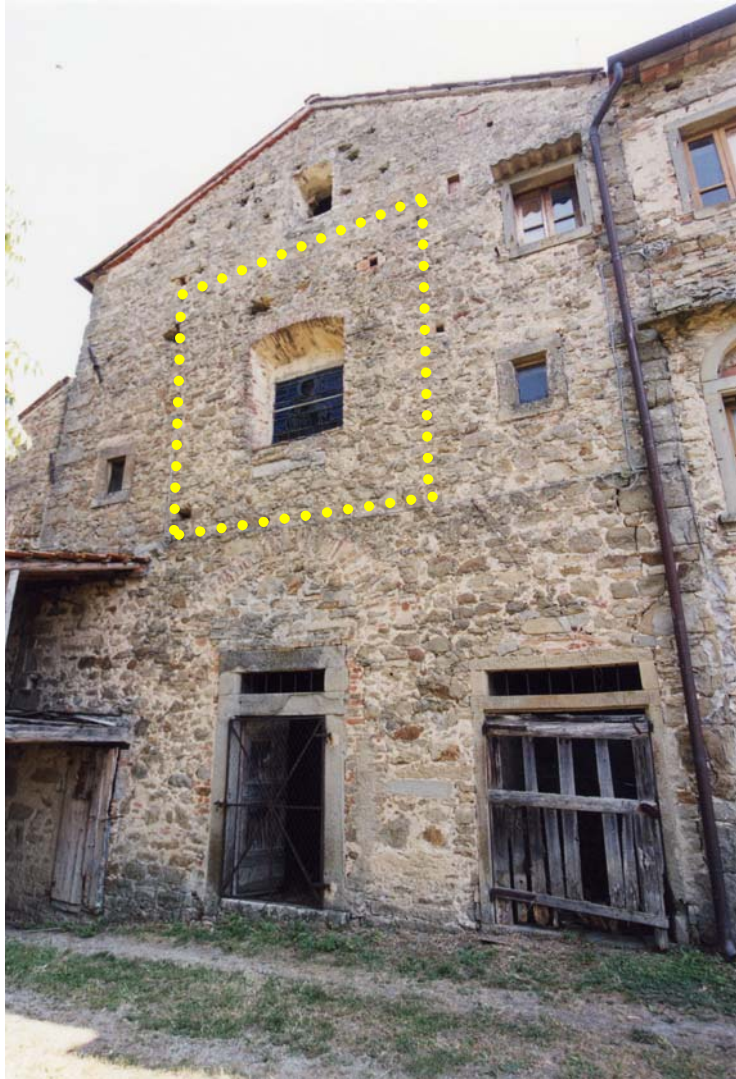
apertura nella parete laterale destra e catena longitudinale
